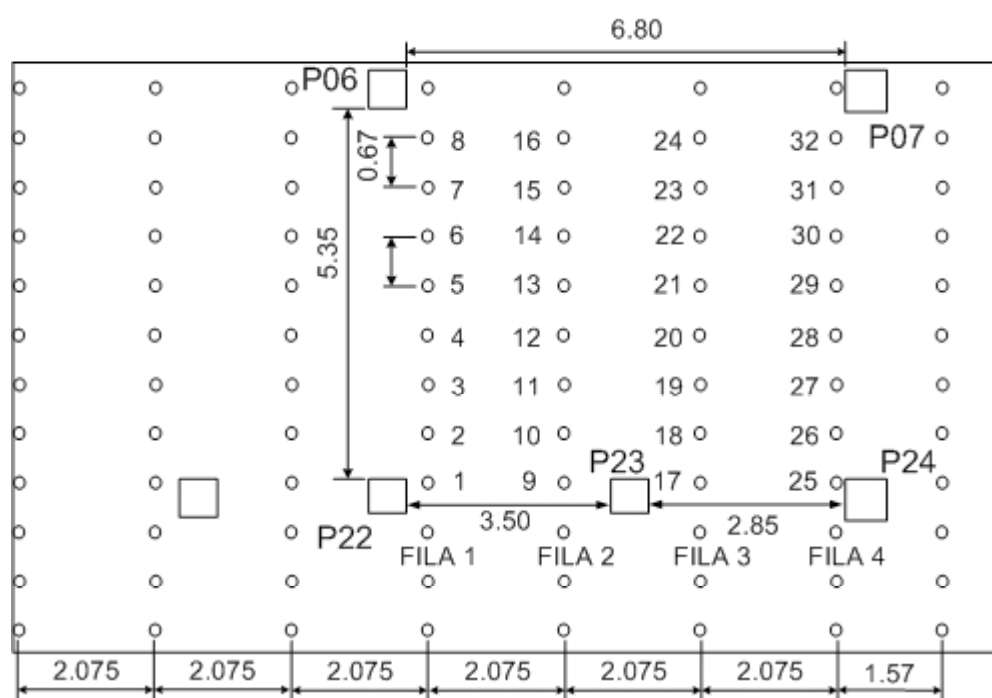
Vista en planta del damero de mediciones en Getaria (cotas en m).
